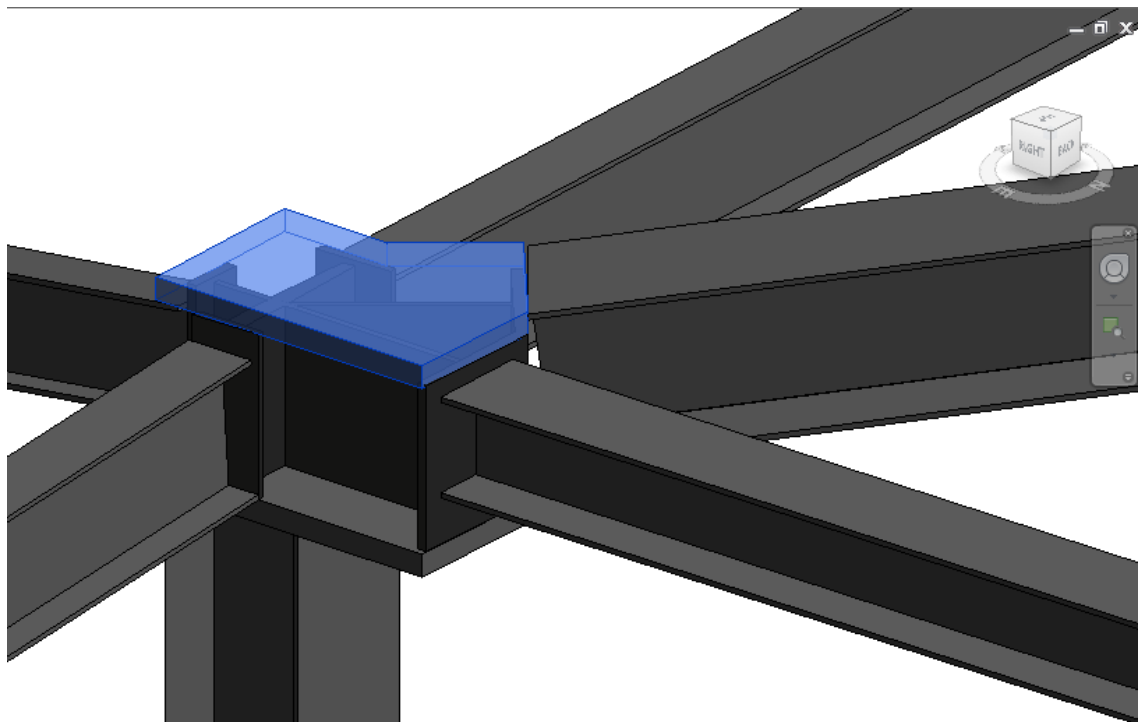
2ª Visualização tridimensional da ligação entre 5 vigas e um pilar
